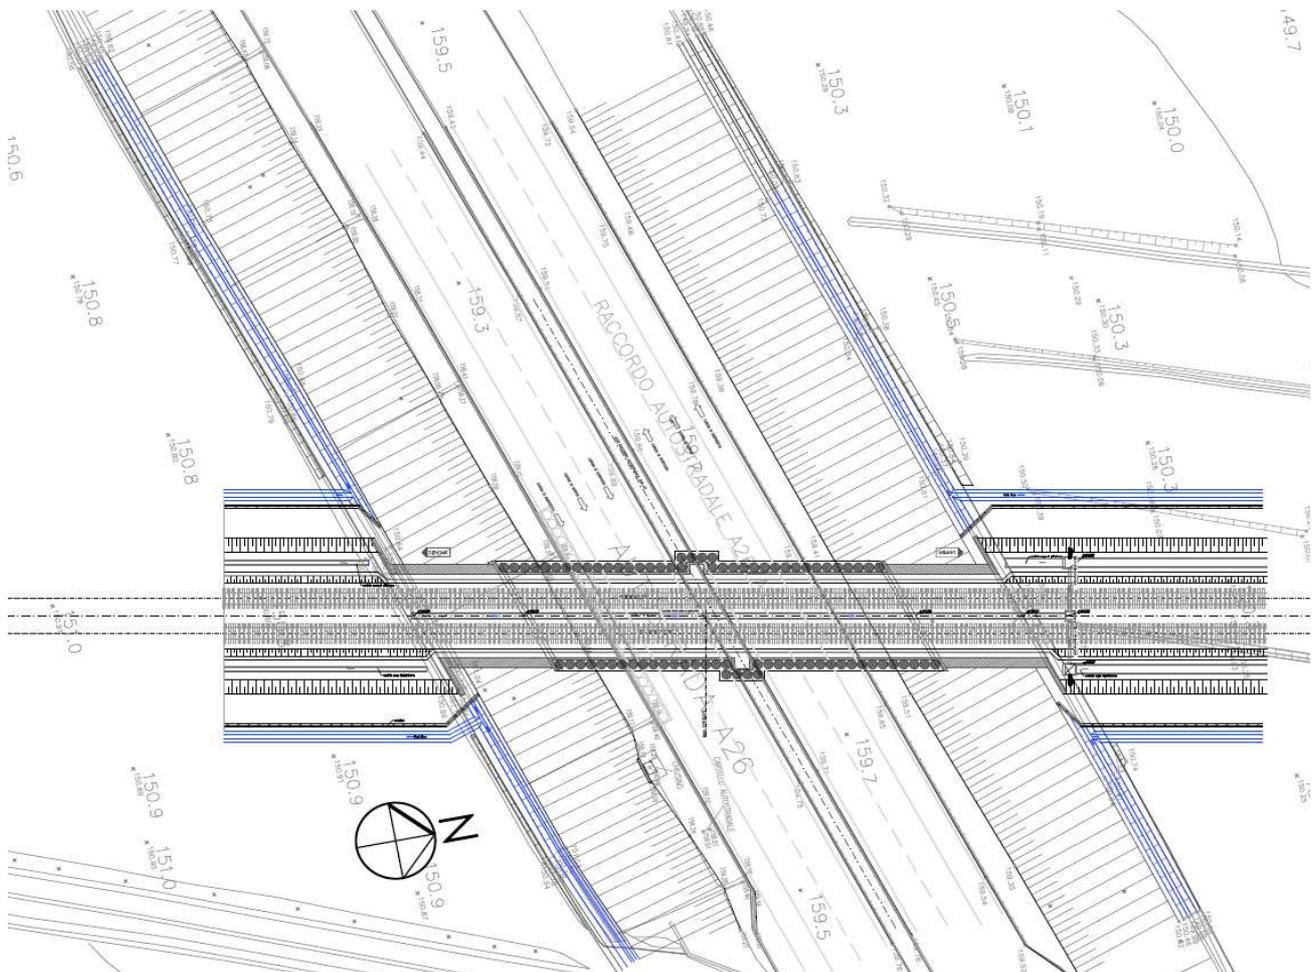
schema di drenaggio delle acque interessanti la sede autostradale
